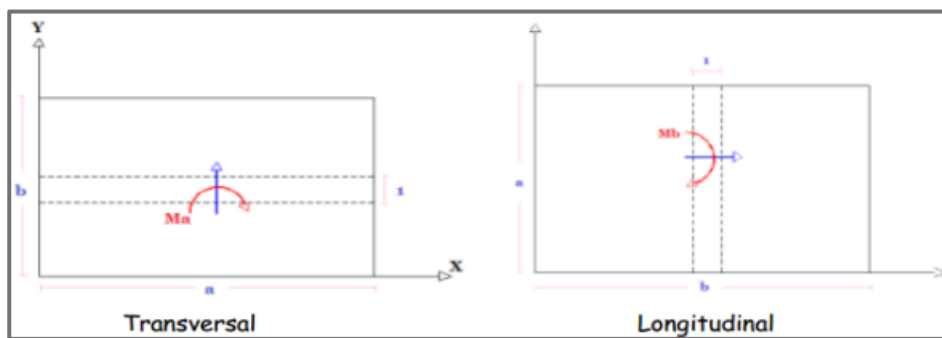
Moments Transversal et Longitudinal sur la dalle centrale.
